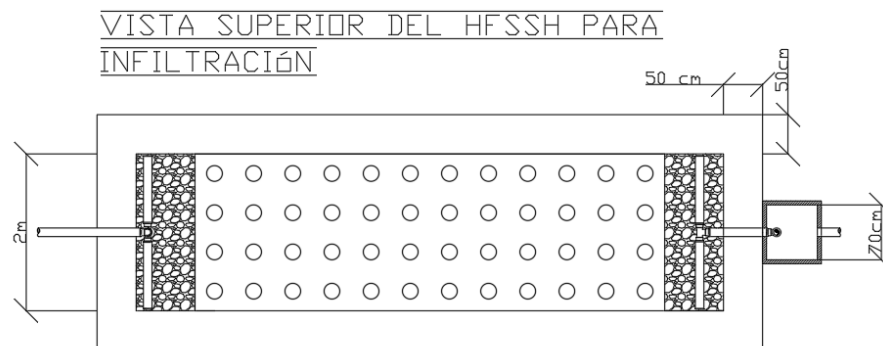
NOTA: PLANO DEL HFSSH PARA INFILTRACIÓN VISTA SUPERIOR. ELABORACIÓN PROPIA
